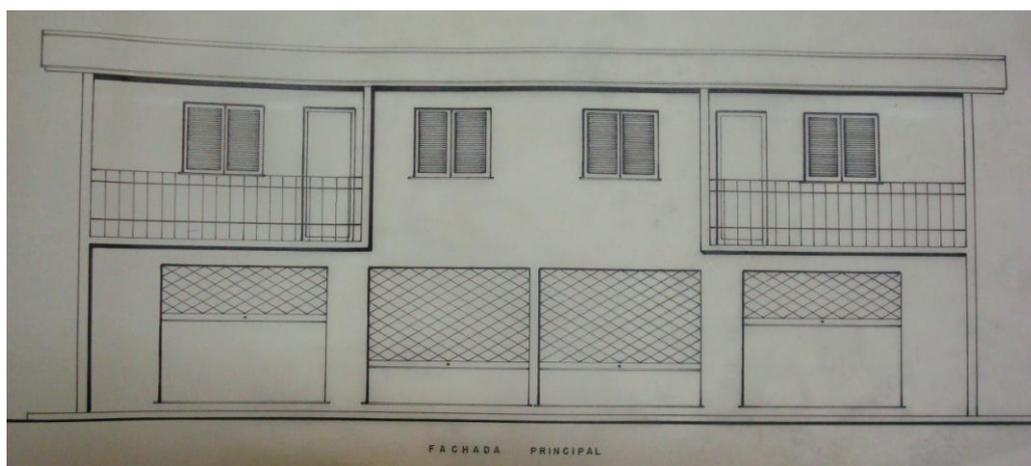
Fachada das casas tipo M (Fonte: Cohab)
